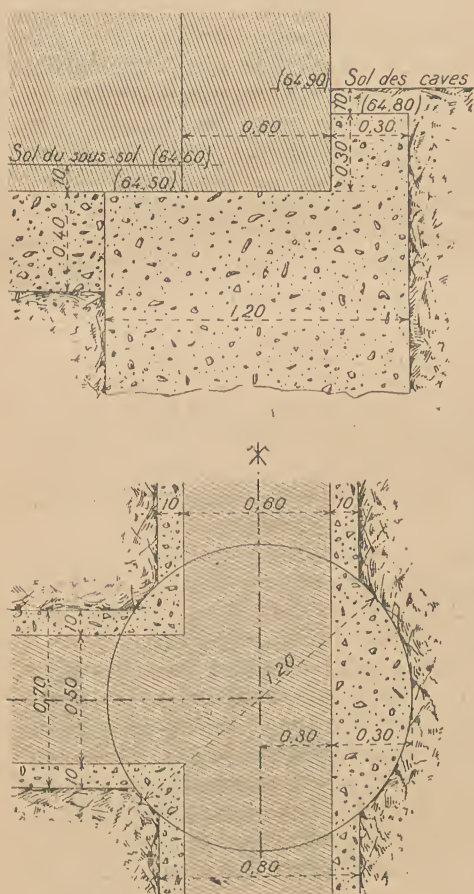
et 5. — Coupe suivant l'axe et plan d'un puits à cheval sur un décrochement de sol de cave.
